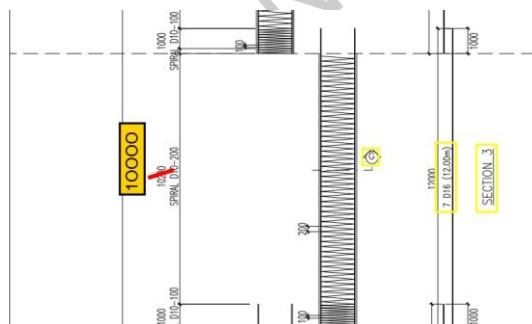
37 Shop drawing detail tulangan bored pile type G section G
